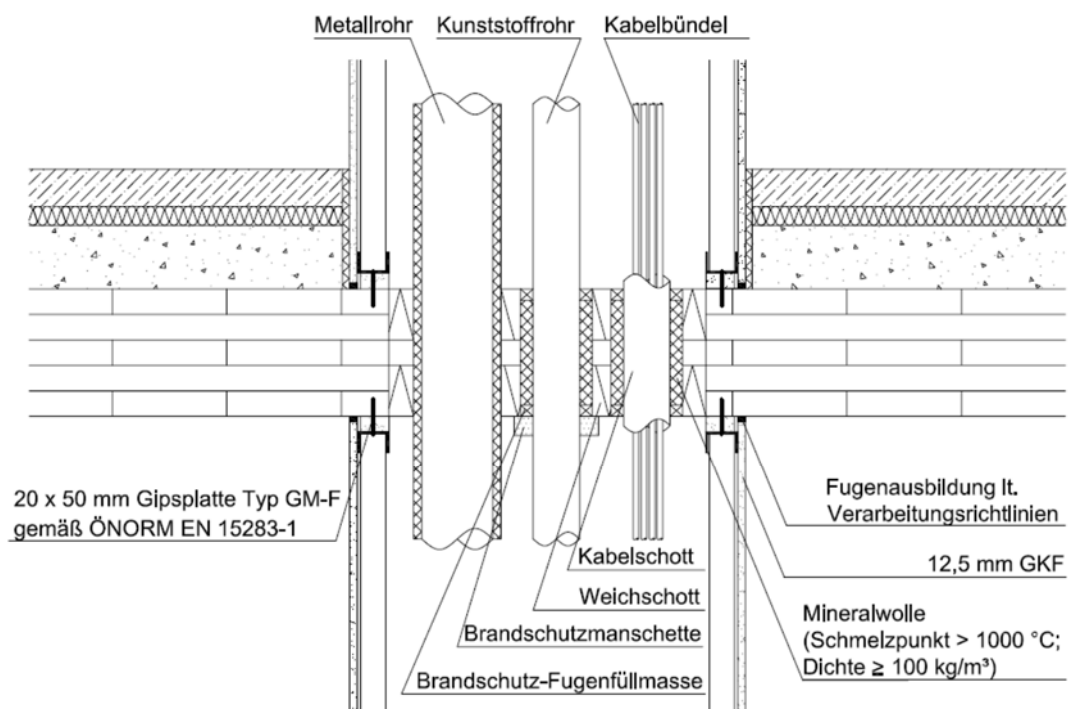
Beispielhafte Ausbildung einer horizontalen Abschottung im Bereich einer Massivholzdecke (Schachttyp B)
